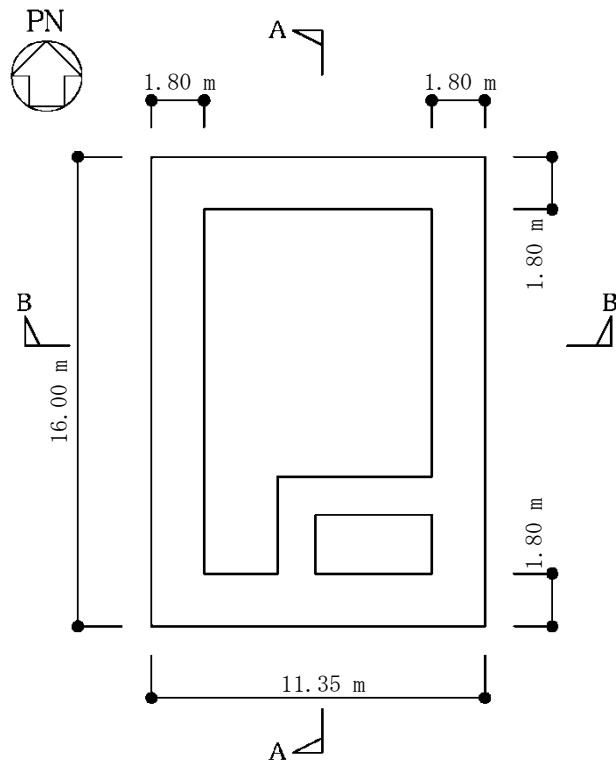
格納槽の概略平面図 (EL. -12.8 m)
